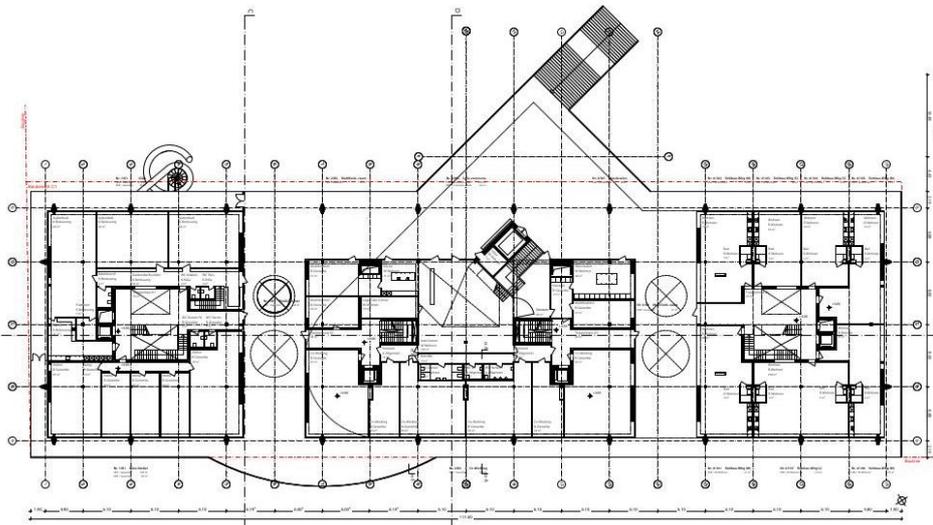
Terrasse mit Stadtbalkon und Freitreppe im ersten Obergeschoss, Studio Trachsler Hoffmann, Atelier Loidl, April 2020
